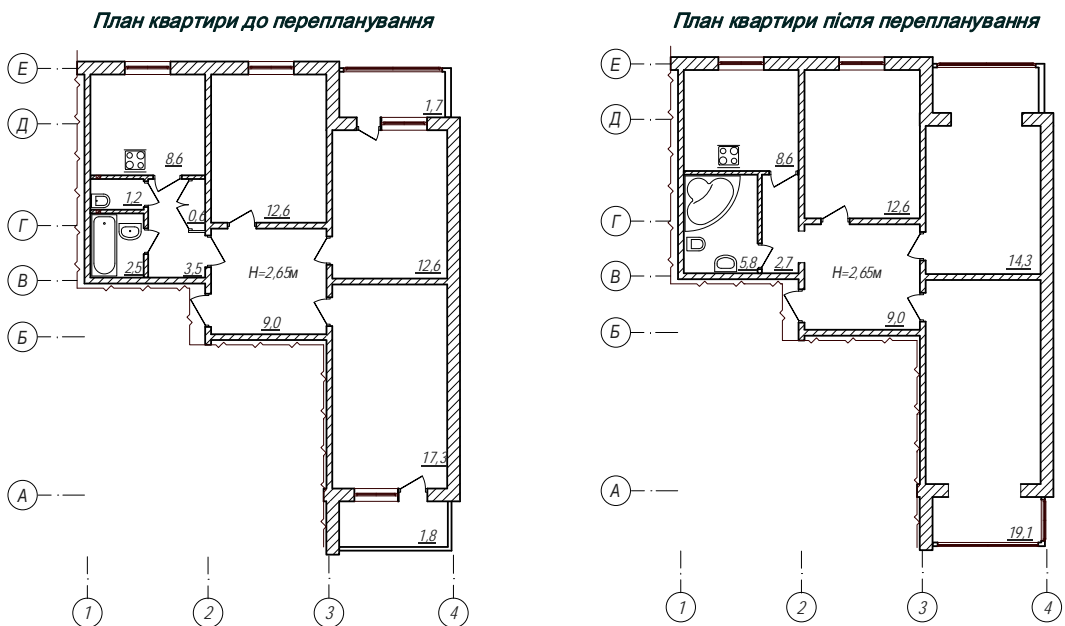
Найбільш поширений варіант перепланування трикімнатної квартири в житловому будинку серії КР-94
